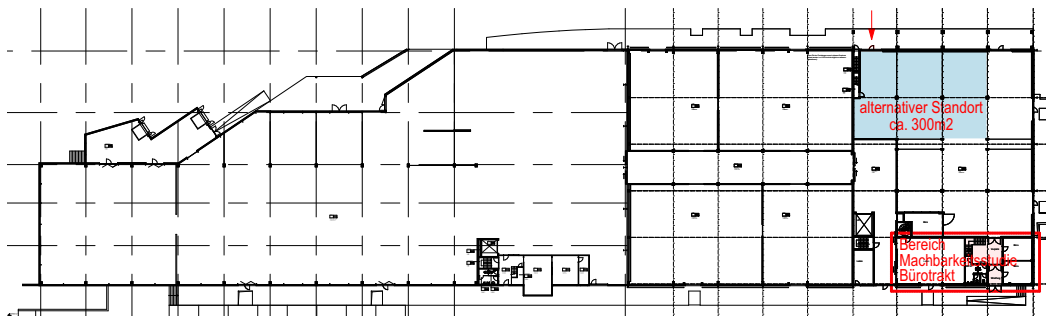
Gewerbebaute Eichenweg 31-39 mit markiertem alternativem Standort
